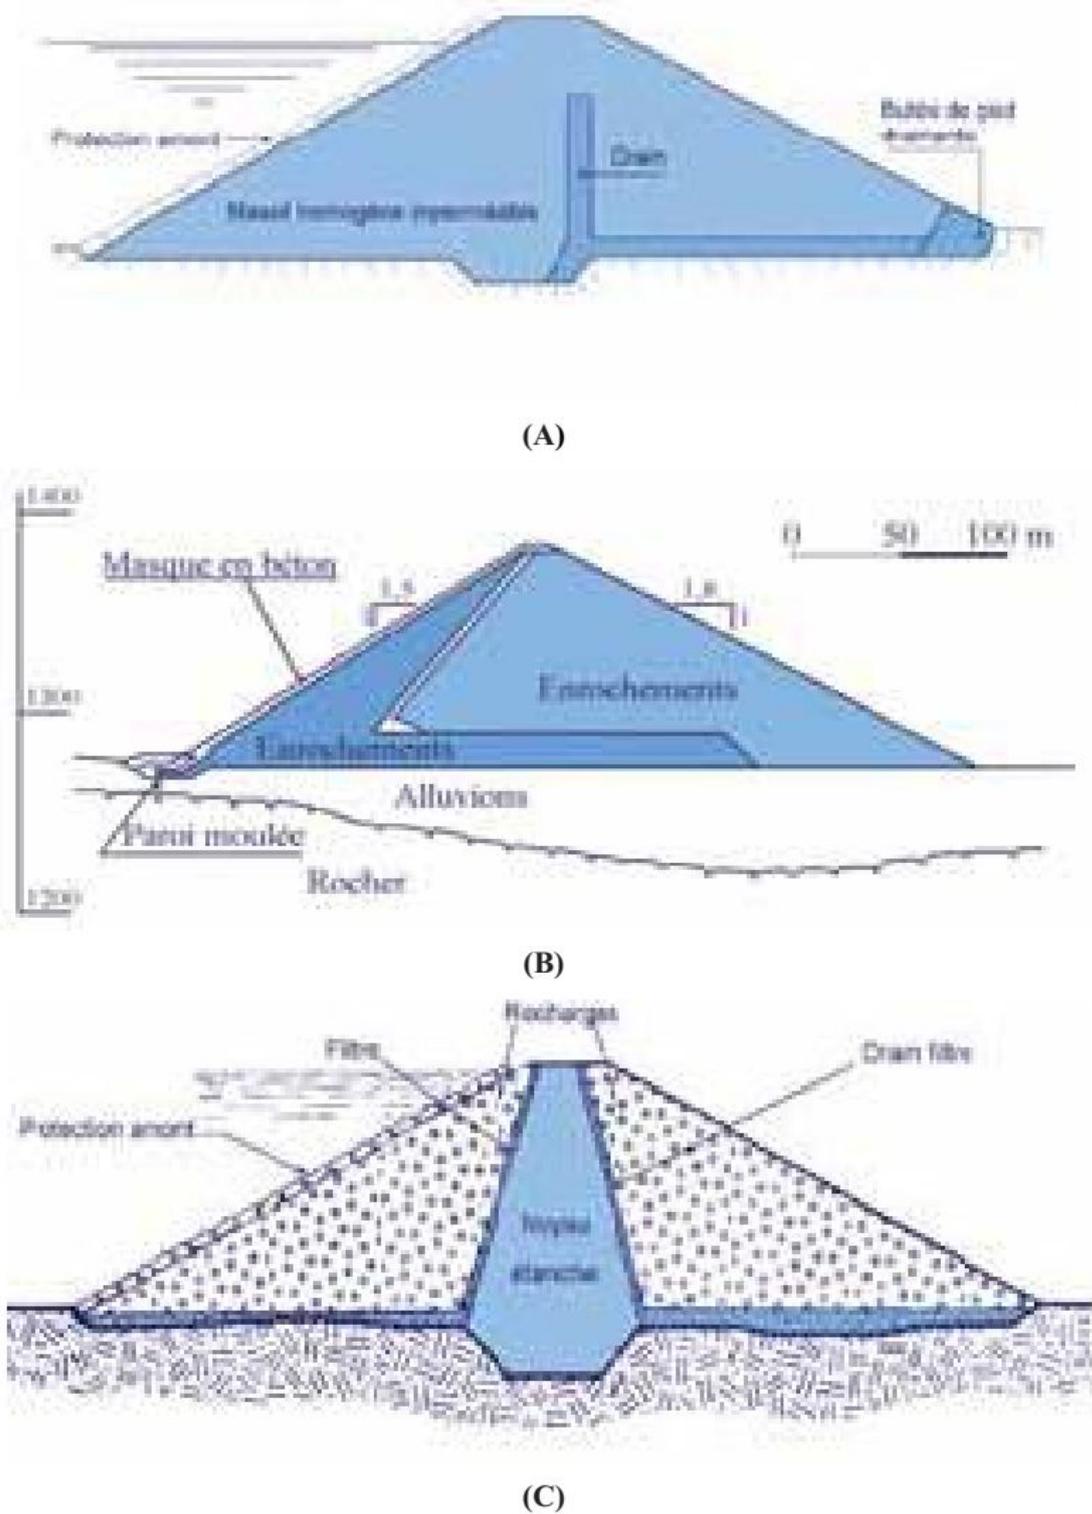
Coupe d'un barrage en terre homogène (A), à masque amont étanche (B), zoné (C), (DELLIOU, 2008).
